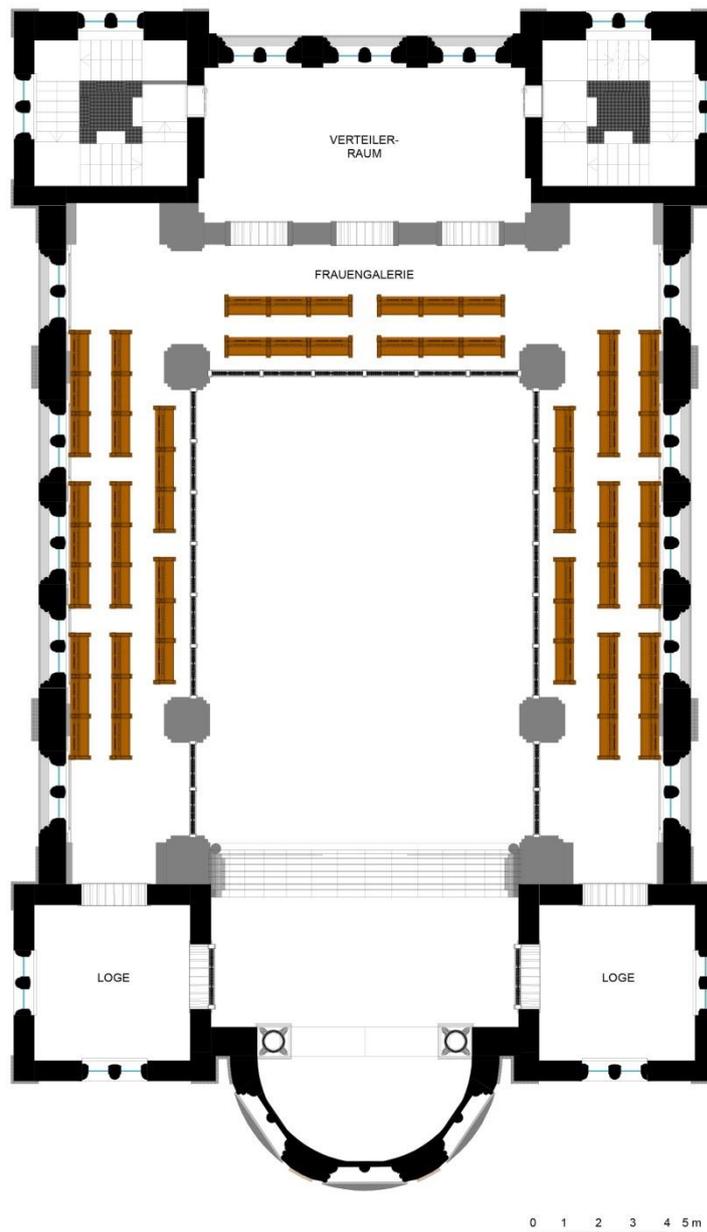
Grundriss 1. Obergeschoß (ARCHICAD)
